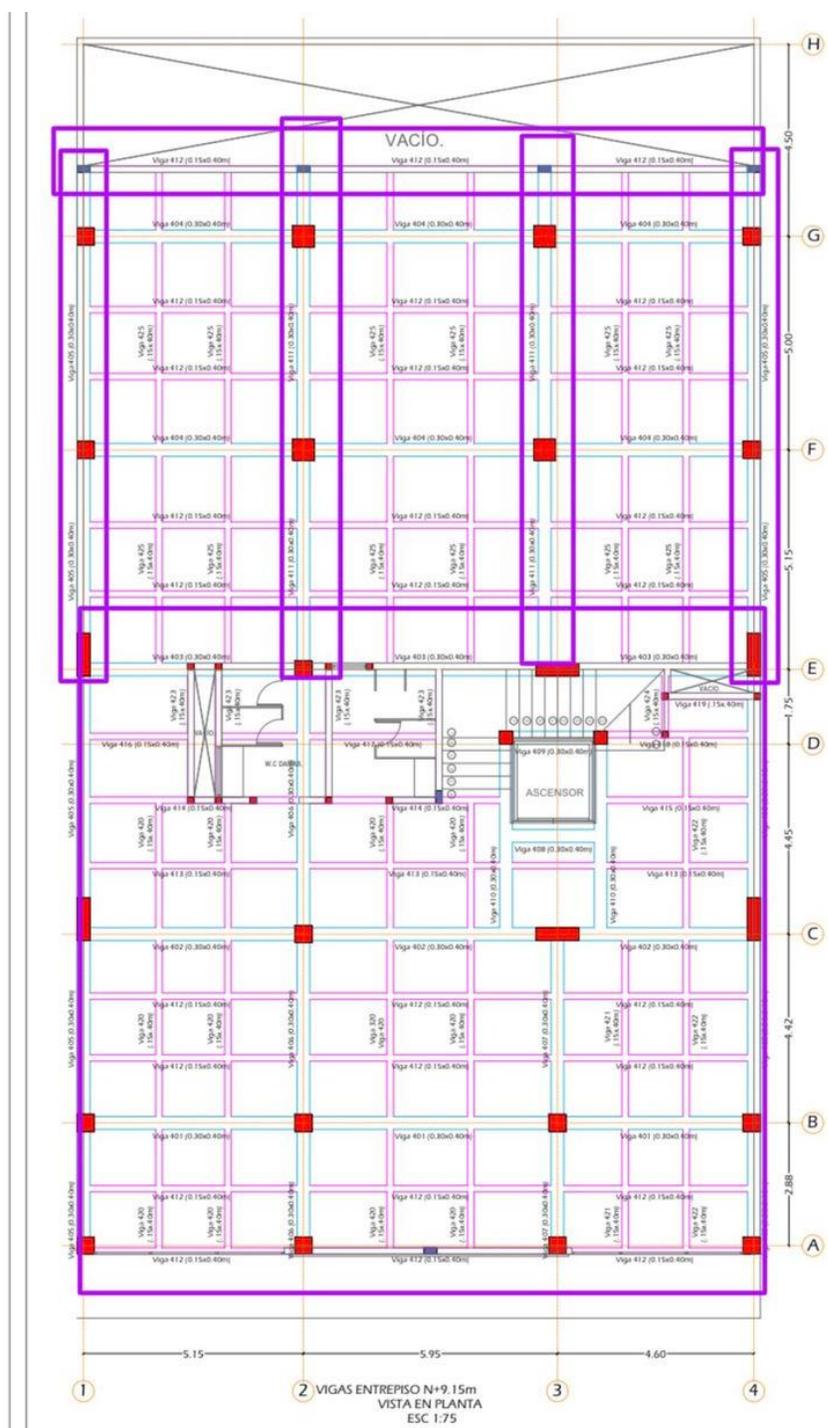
Vista en planta de Vigas armadas a la fecha de 24/10/23 nivel 5 Edificio Wiedii
